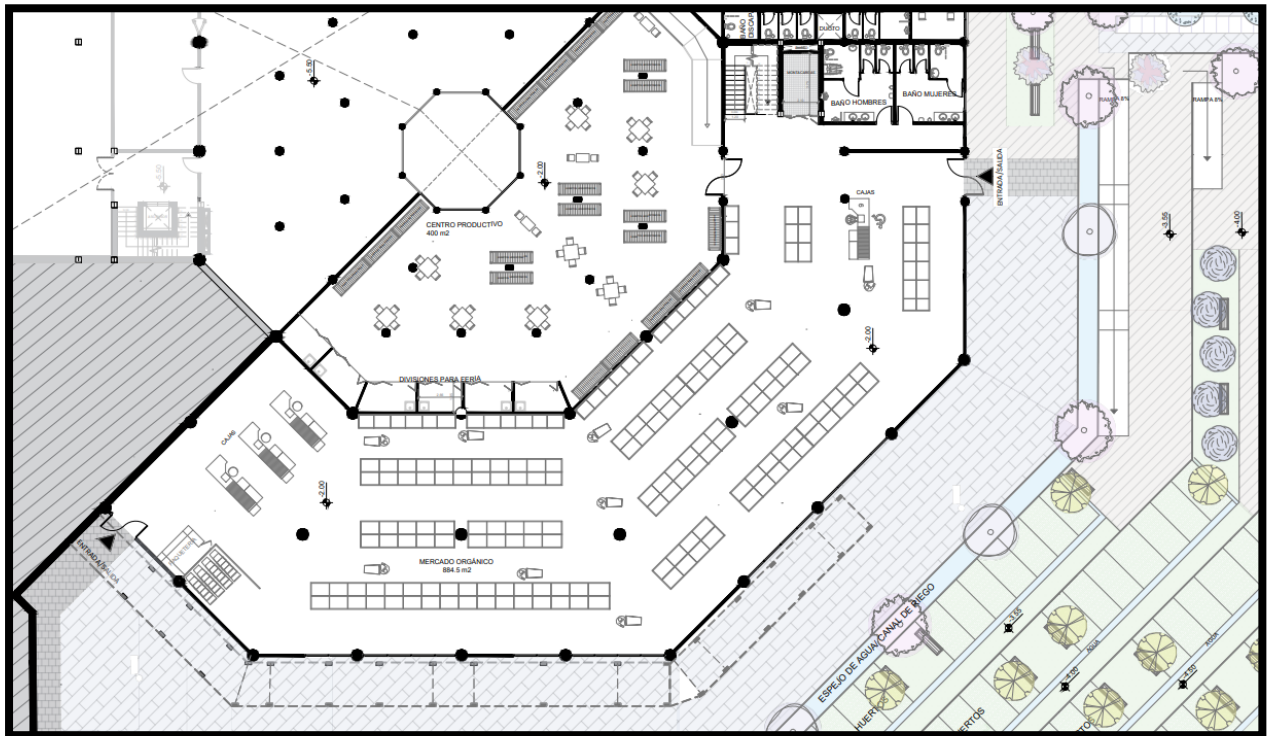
Planta Mercado Nivel -2.00 Ramires S. 2023
